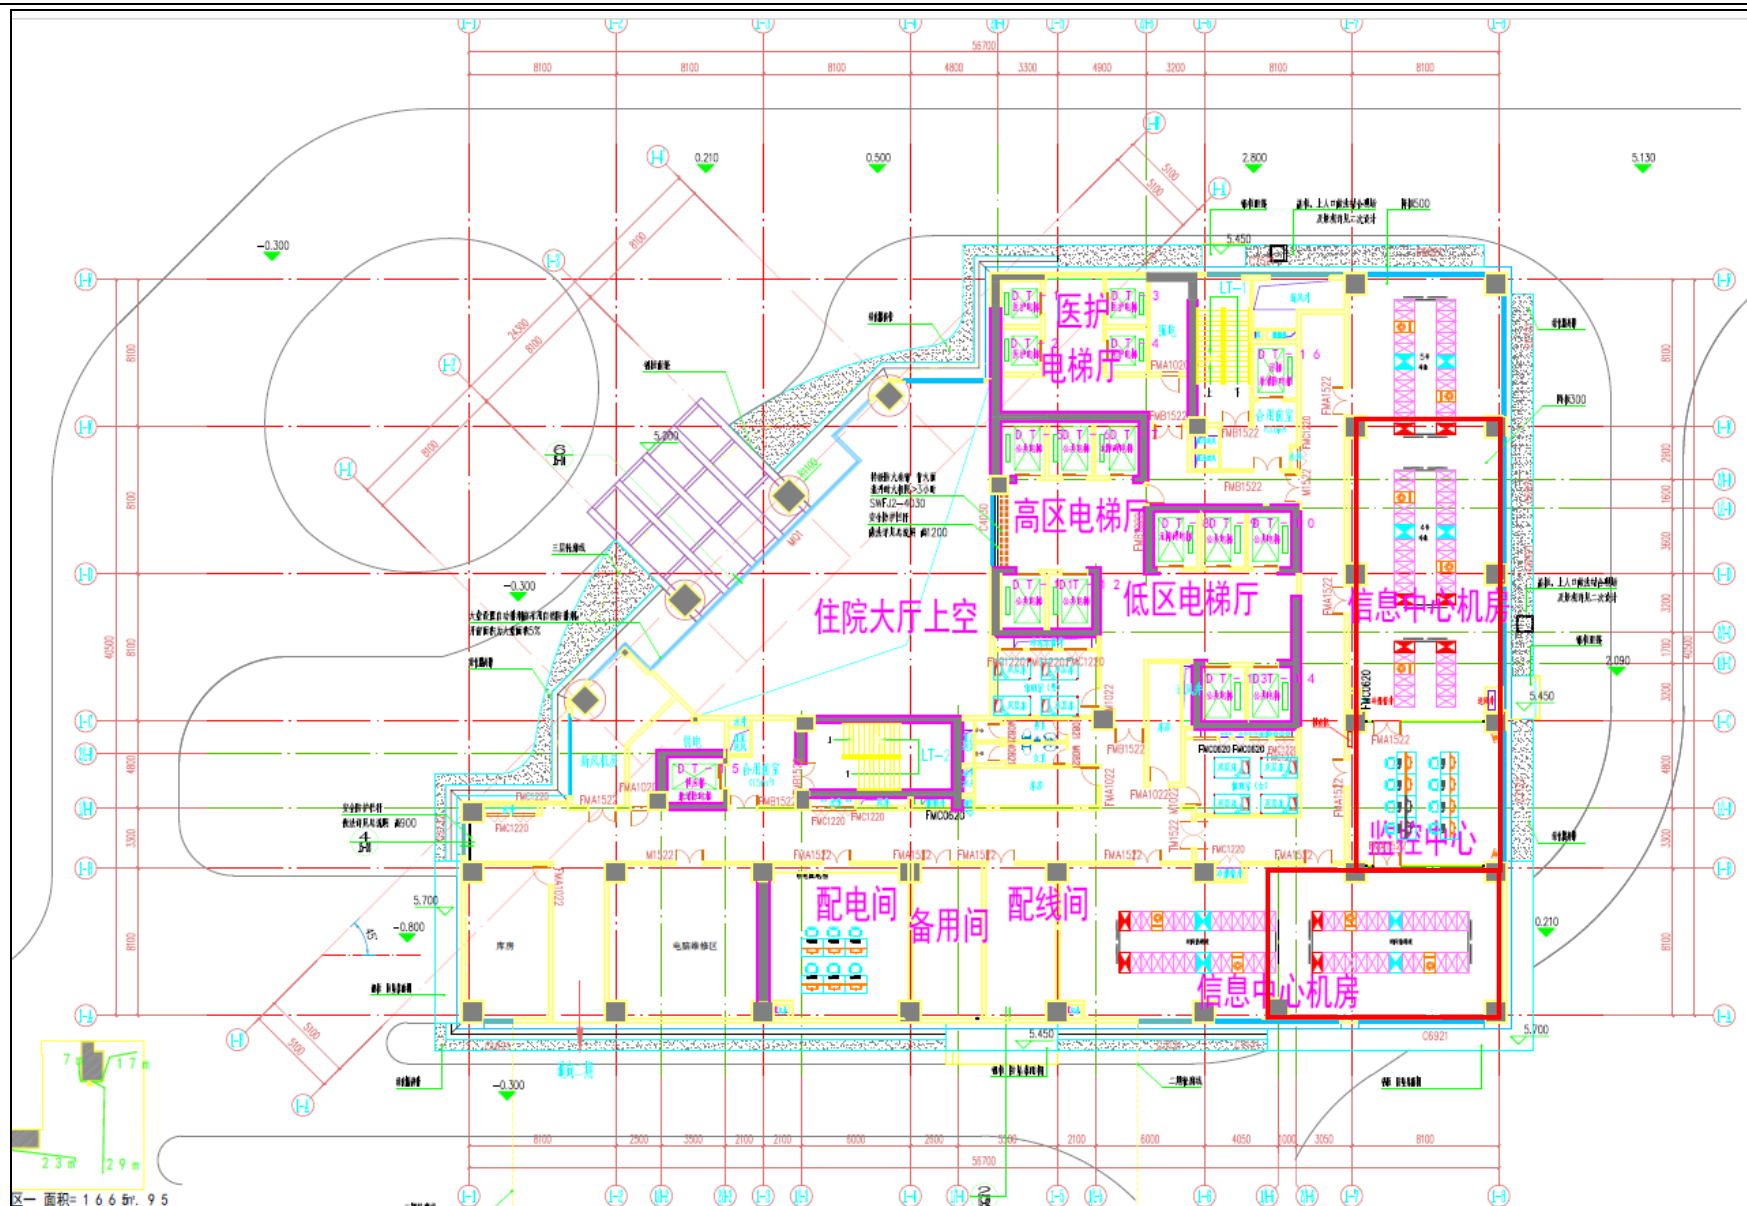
内科综合楼三层介入室楼下（投影）二层设备层平面布置图
